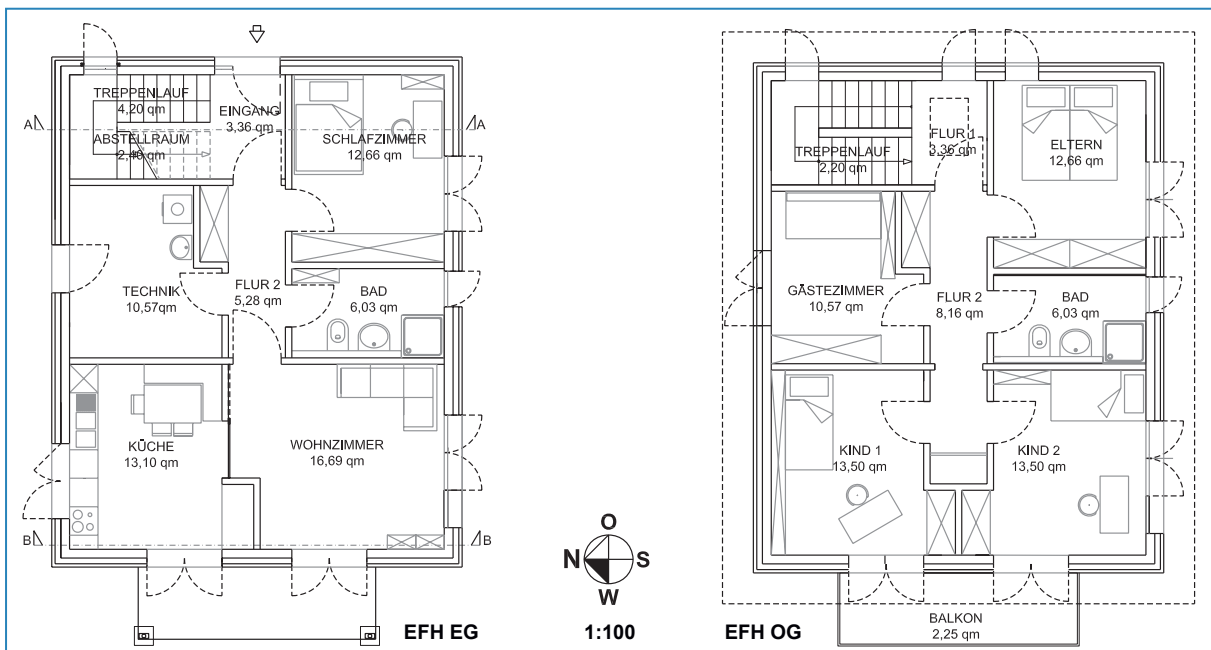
Grundrisse des untersuchten Einfamilienhauses (links: EG, rechts: OG)
